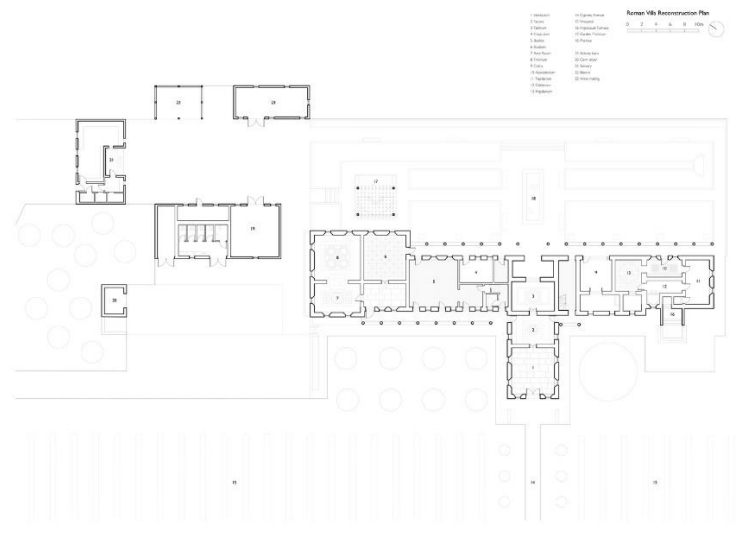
План реконструкції першого поверху вілли Гадспен [17]
